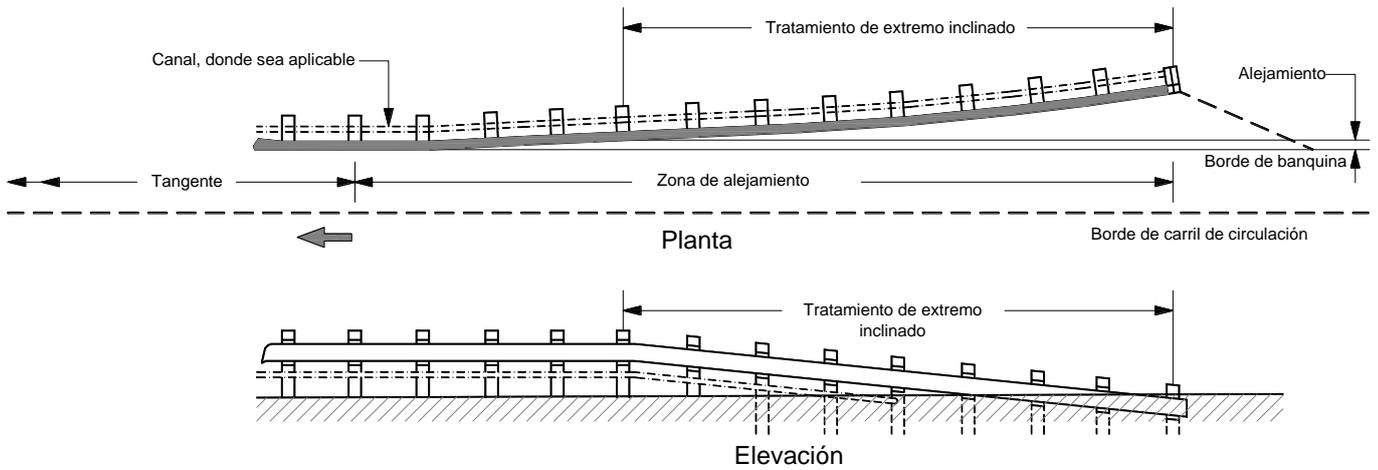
BARRERA DE VIGA DE ACERO UTILIZANDO TRATAMIENTO DE EXTREMO ENTERRADO Y DESVIADO
